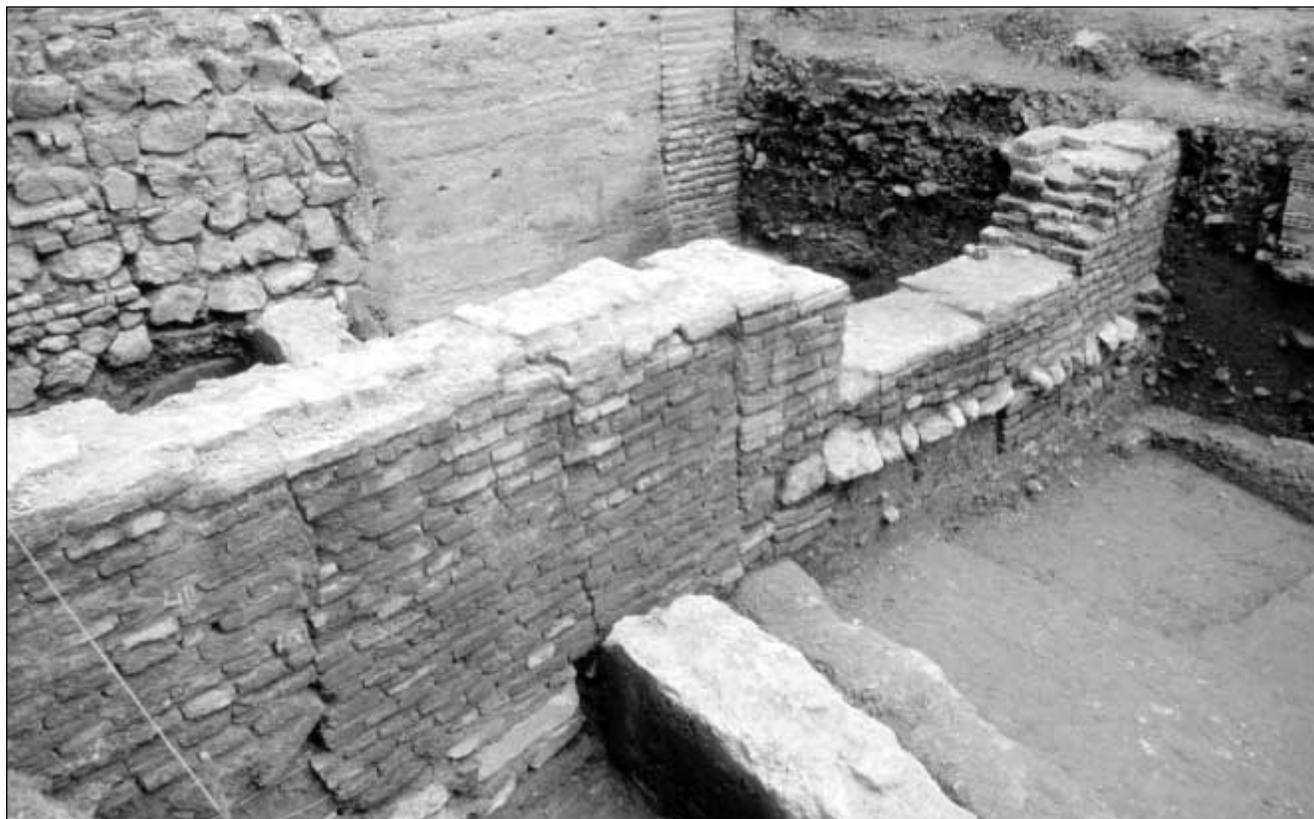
Detalle de los elementos constructivos. Tramo de murallas y Torreón al fondo.
